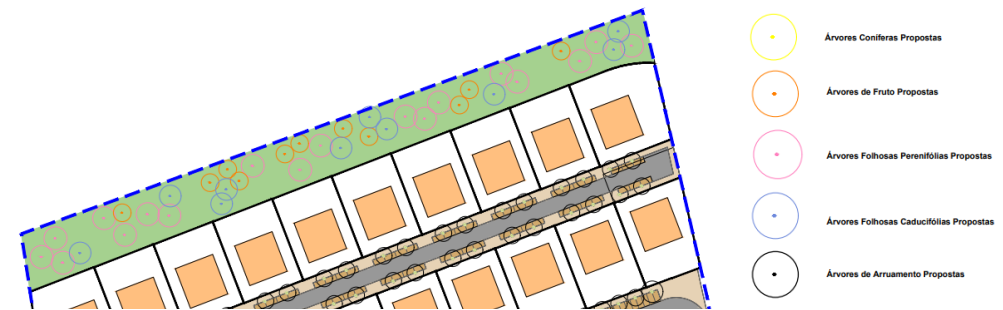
Detalhe do Projeto de Arranjo Paisagístico
